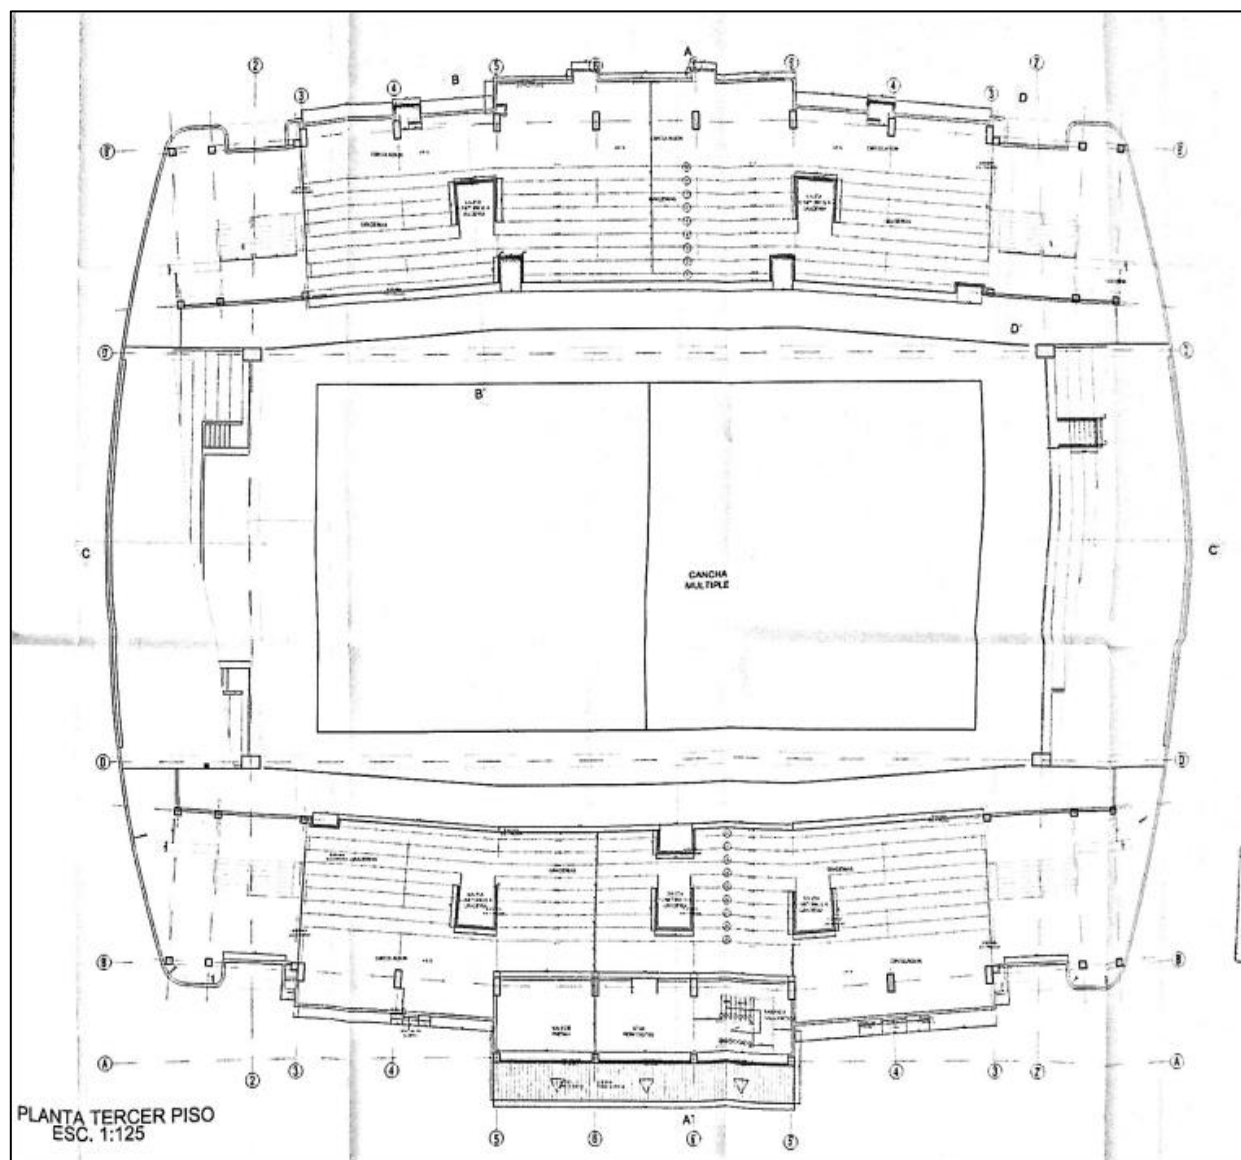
Planta General Tercer Piso Coliseo León XIII.
